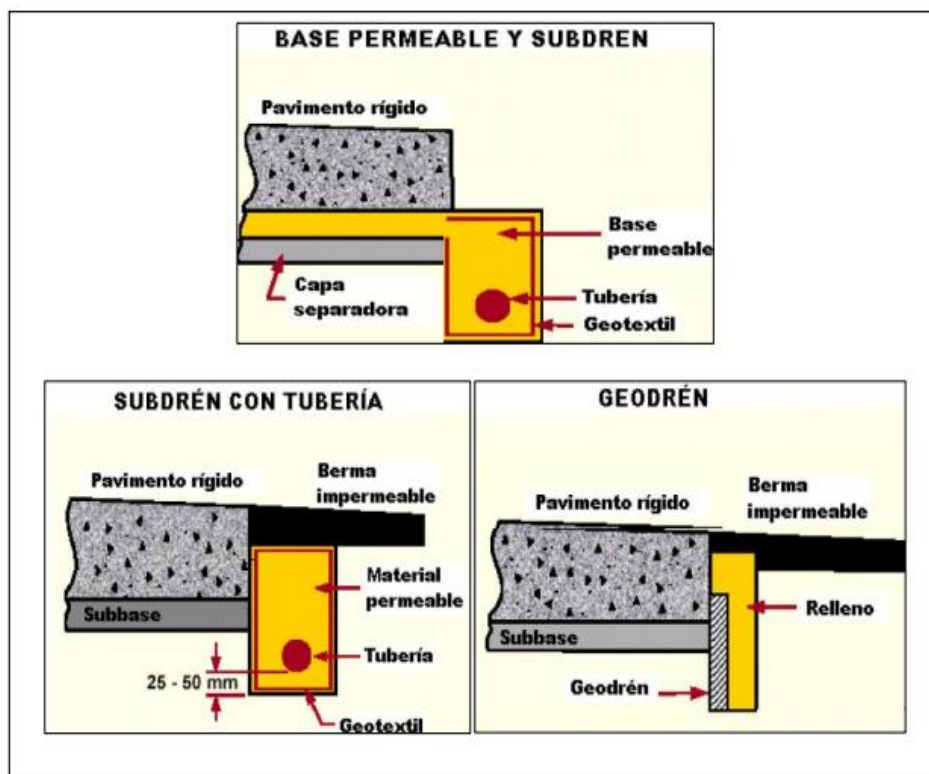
Se observa la tubería longitudinal (Manual para el diseño de carreteras, 2014).
